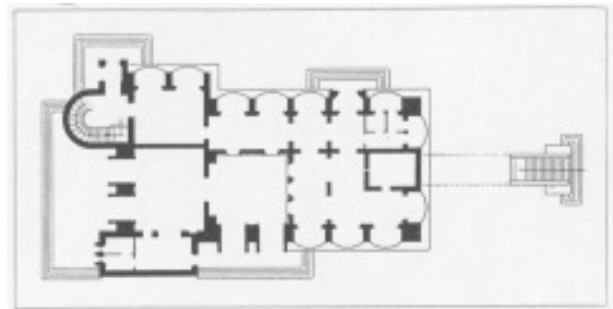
Grundriss des Postamtes in Latina (1932)
